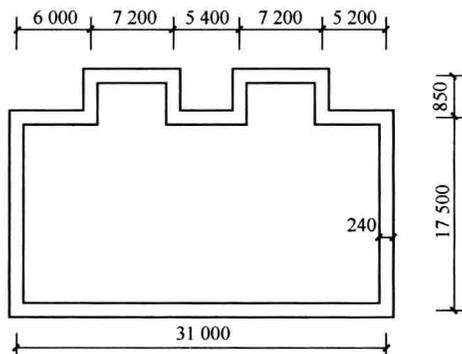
某建筑物底层平面示意图(单位:mm)
